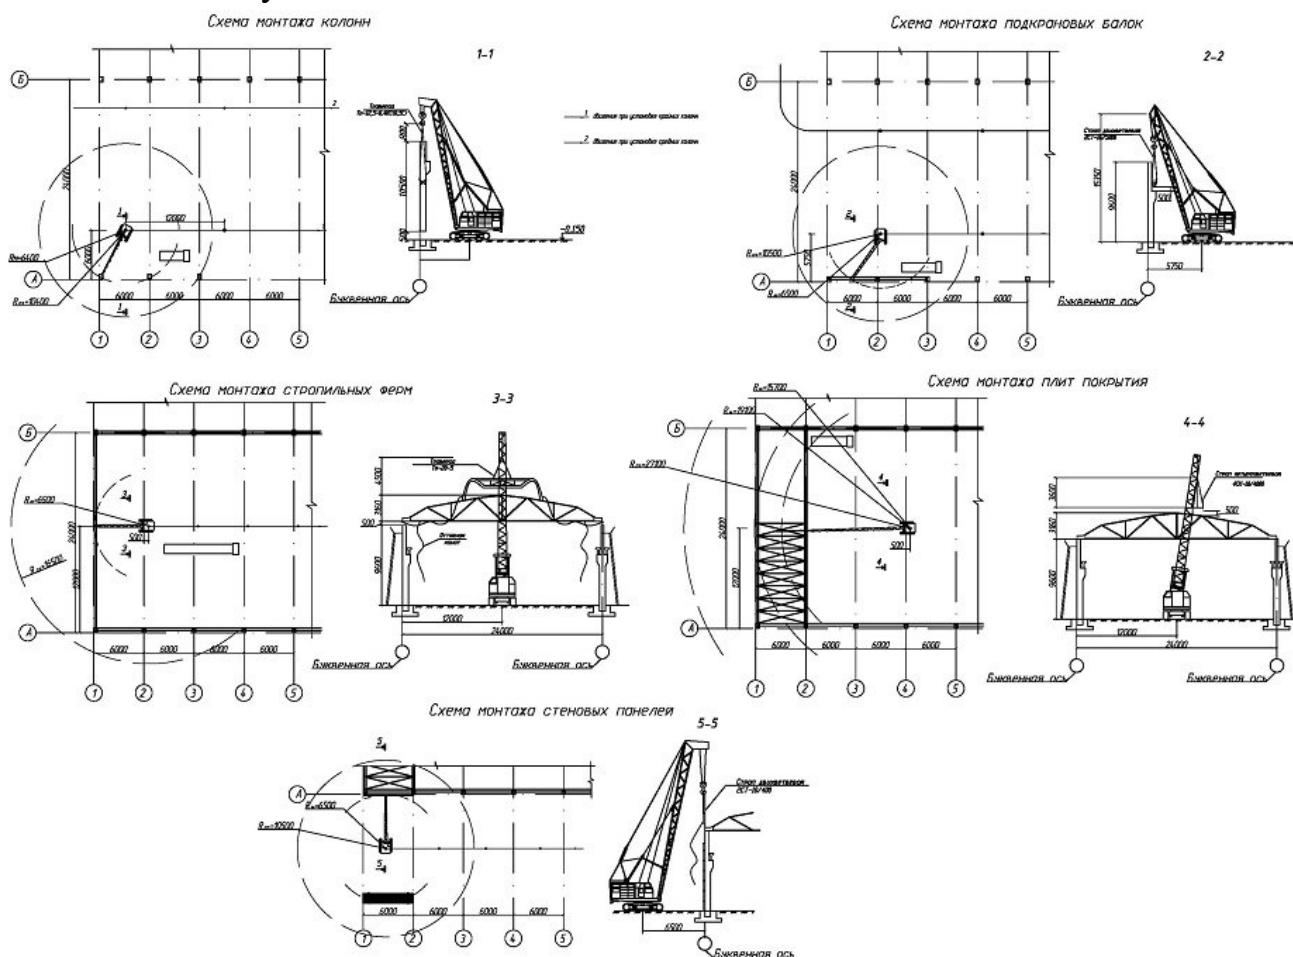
Схема организации работ на монтаж одноэтажного промышленного здания
